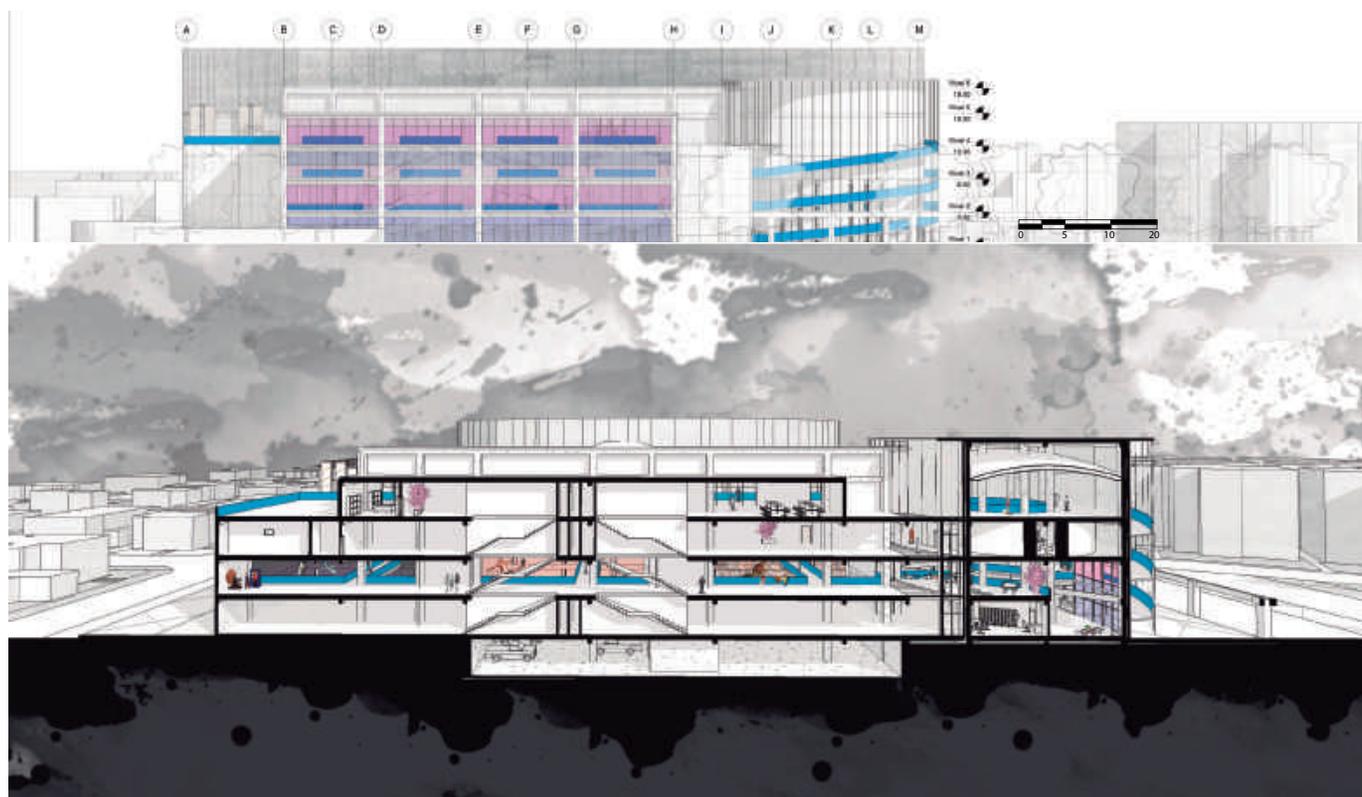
Corte Fugado/ Fachada Oeste. Elaboración propia
